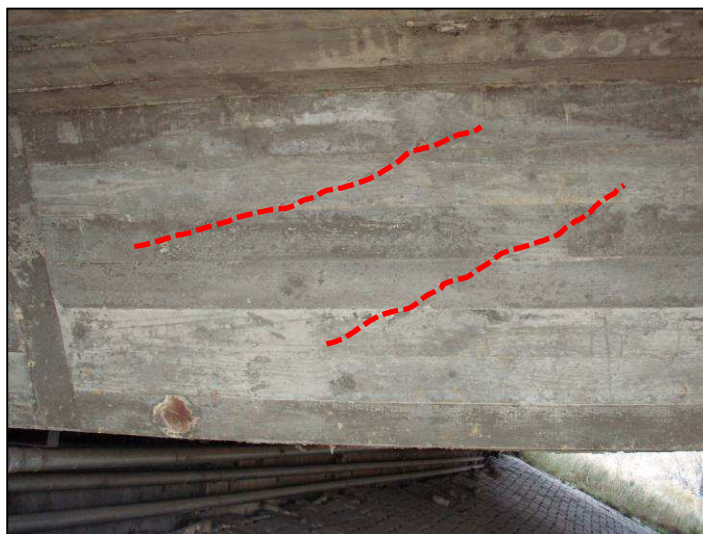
Fisuras a 45° en losa.
